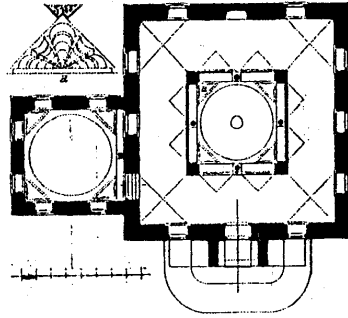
مسقط أفقي لقبة رقية دودو
